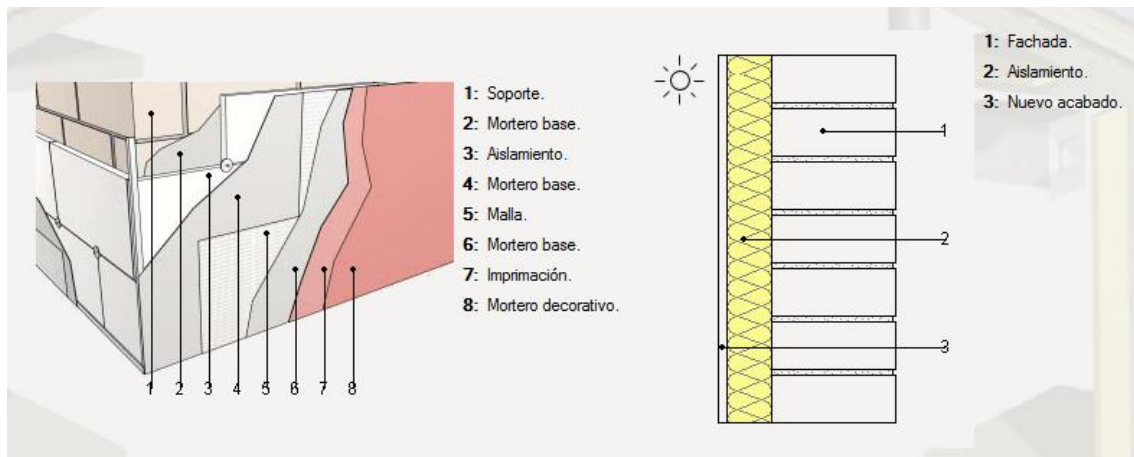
Detalle constructivo: Sistema ETICS. Fuente: Arquimedes
